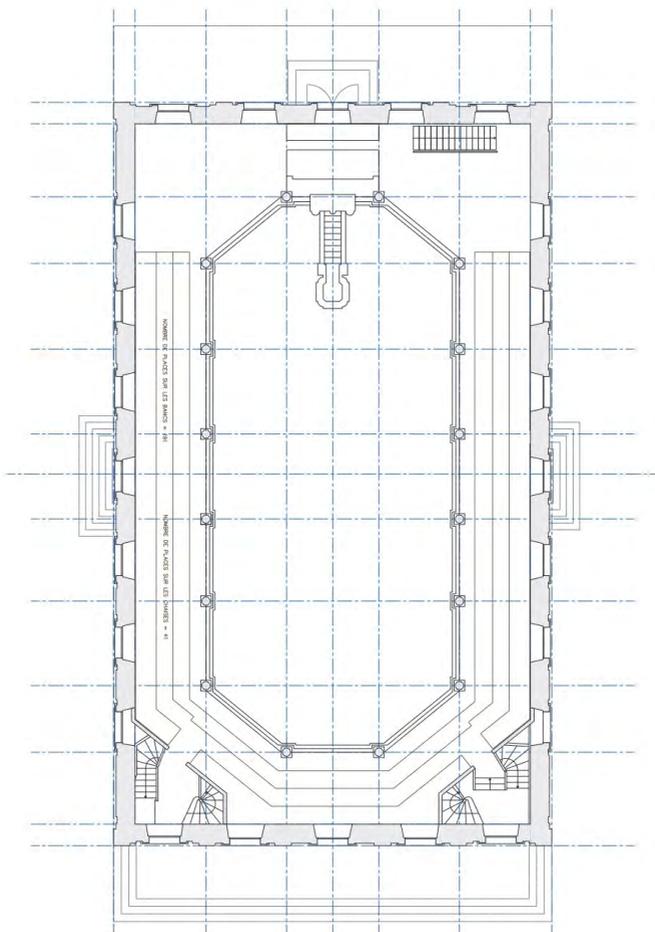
Plan galerie, état existant. Atelier Férocé 2017.
